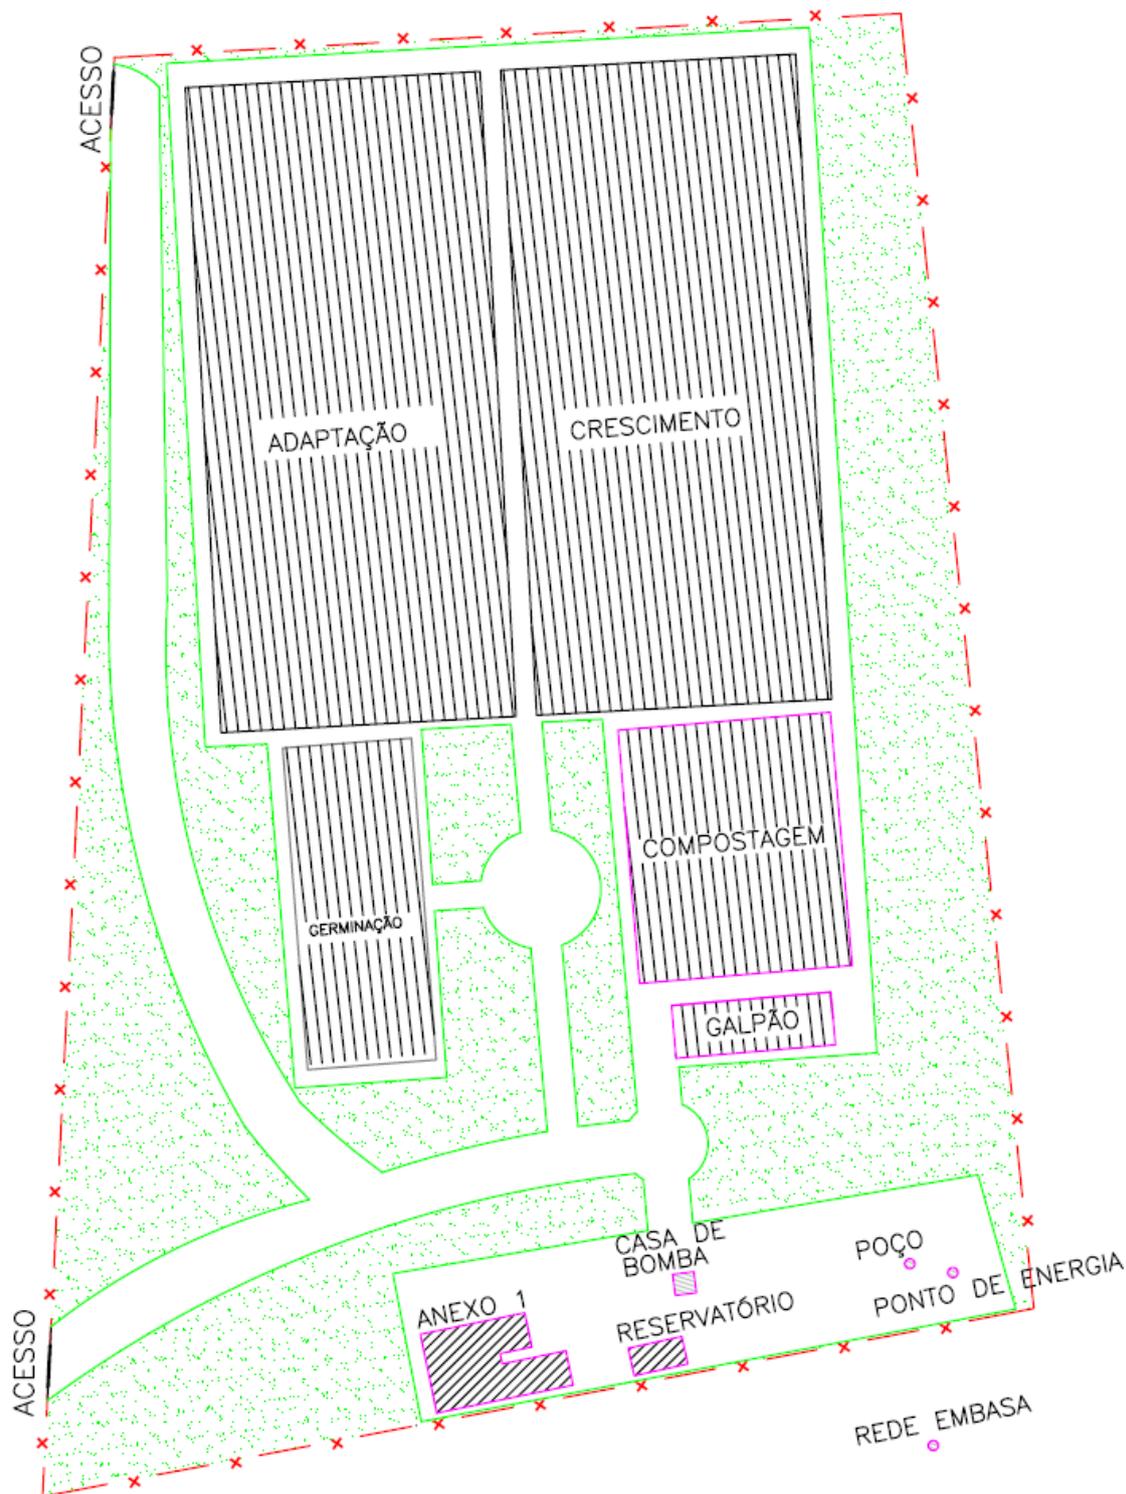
Croqui da planta baixa do viveiro (meramente ilustrativo)
